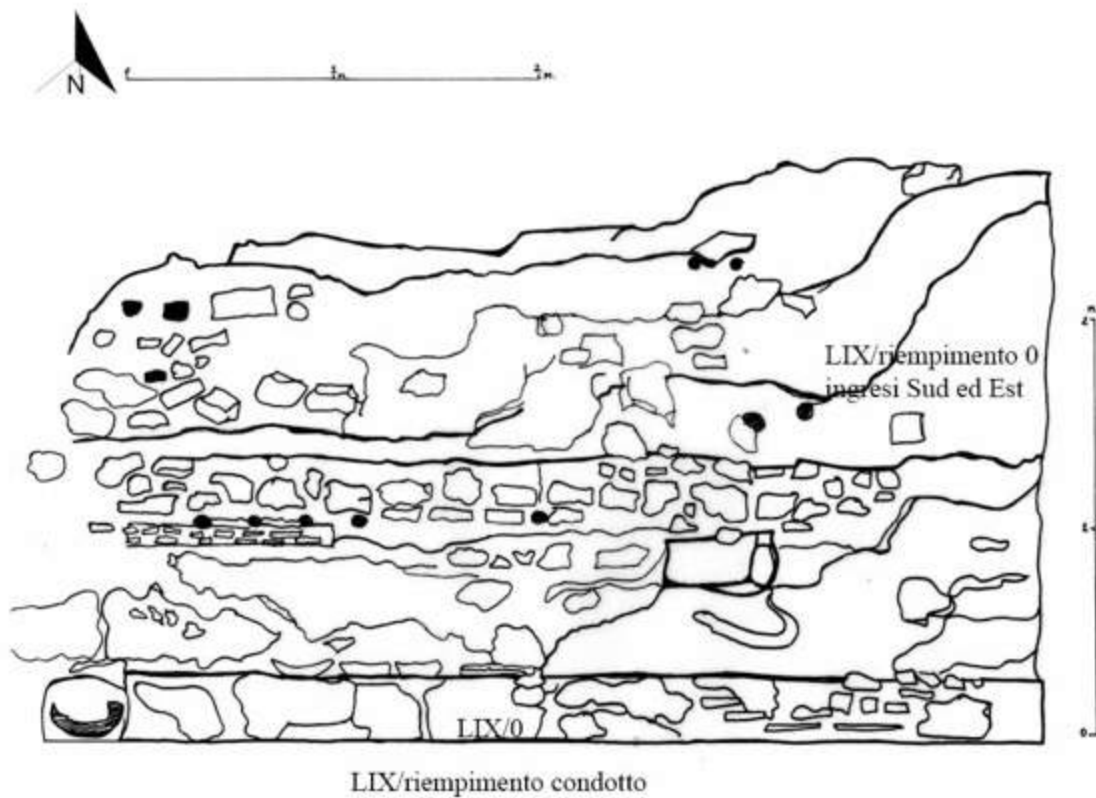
Prospetto del muro nord del vano LIX con indicazione dei tre livelli individuati (disegno dell'Autrice).
